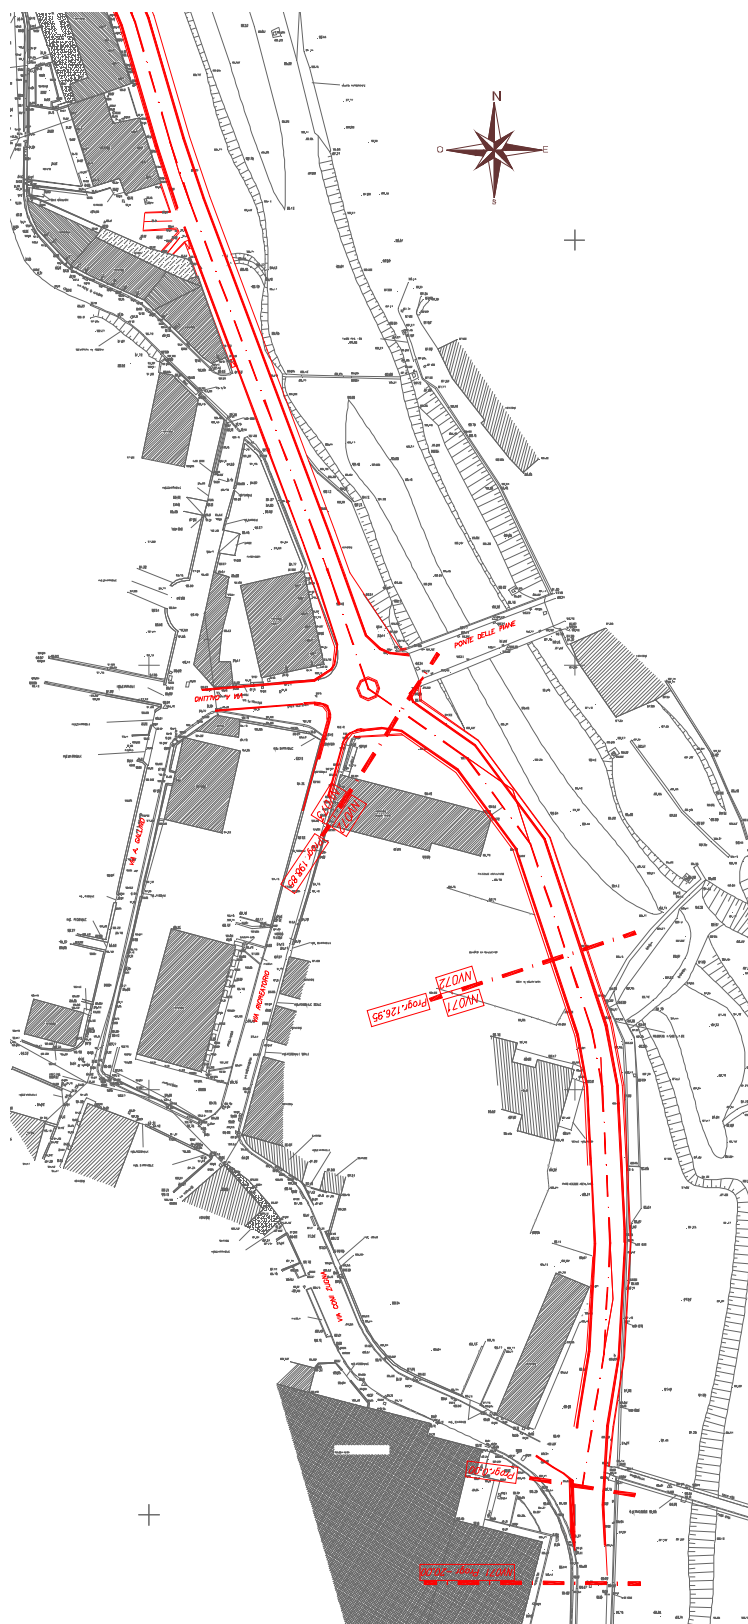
Planimetria Progetto Esecutivo approvato 2 di 2
